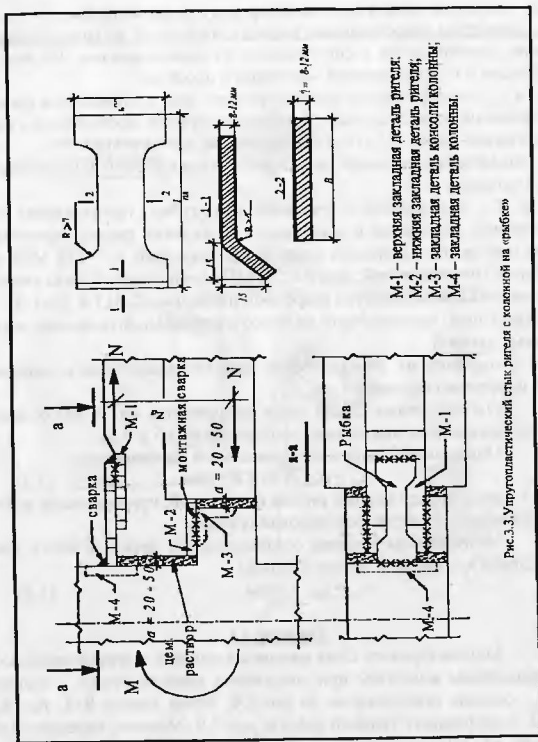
Угругоэластический стык ригеля с колонной на «рыбке»
